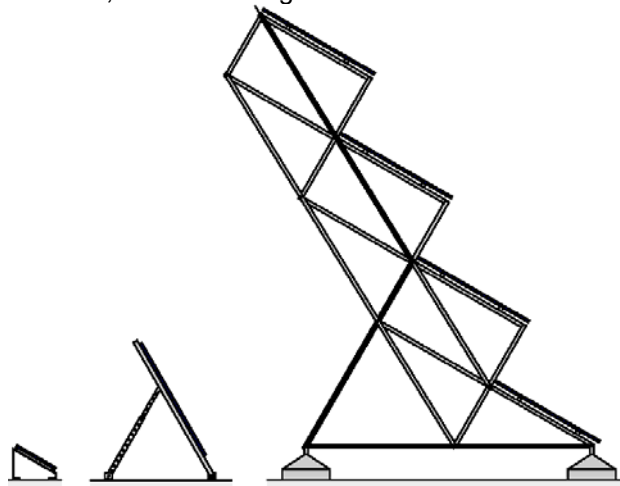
Sistema de montagem em telhados planos com várias alturas de construção
